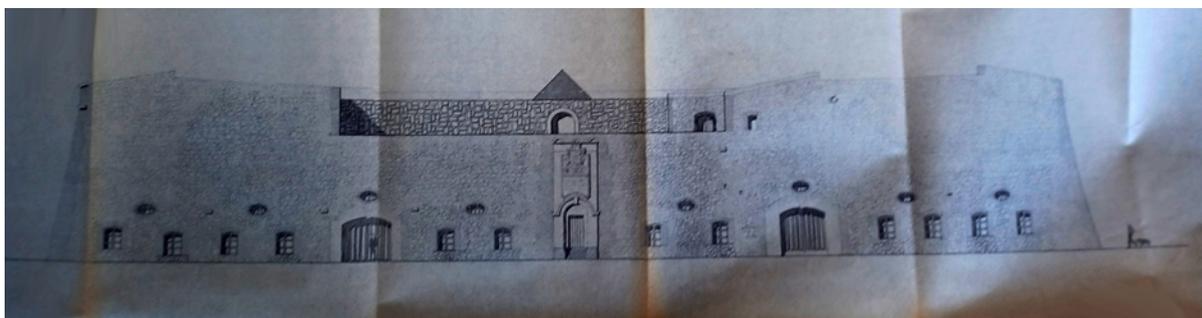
Proyecto de Cubrición. Jaime Antón (1990).
